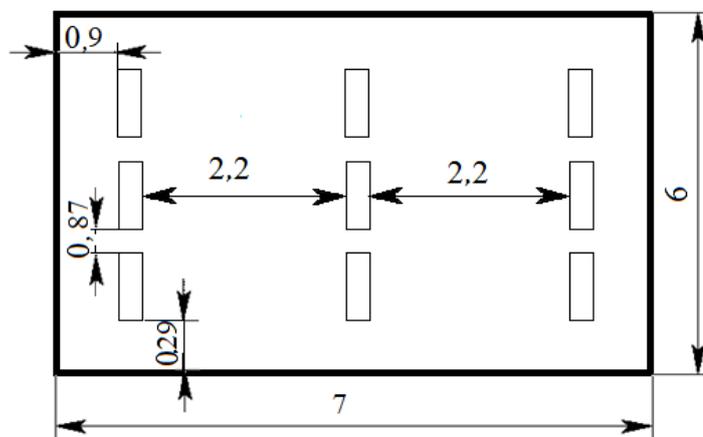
План помещения и размещения светильников с люминесцентными лампами.
